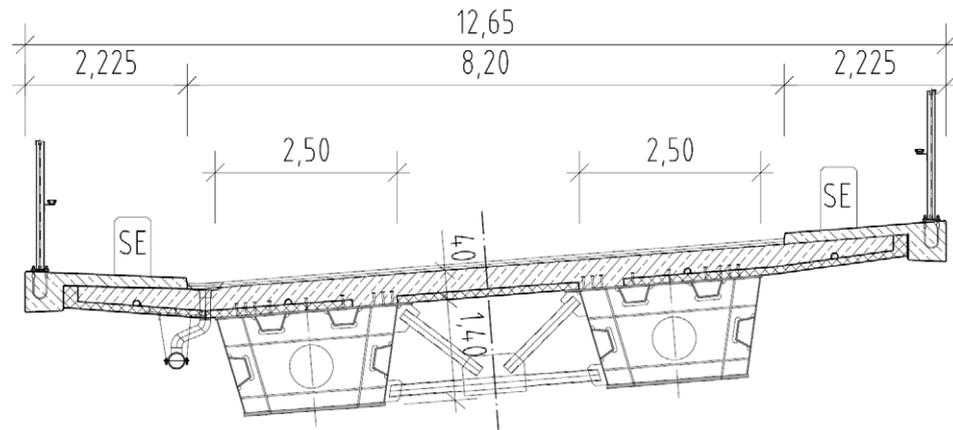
Typischer Querschnitt (Niedermittlau) eines luftdicht verschweißten Hohlkastens.
